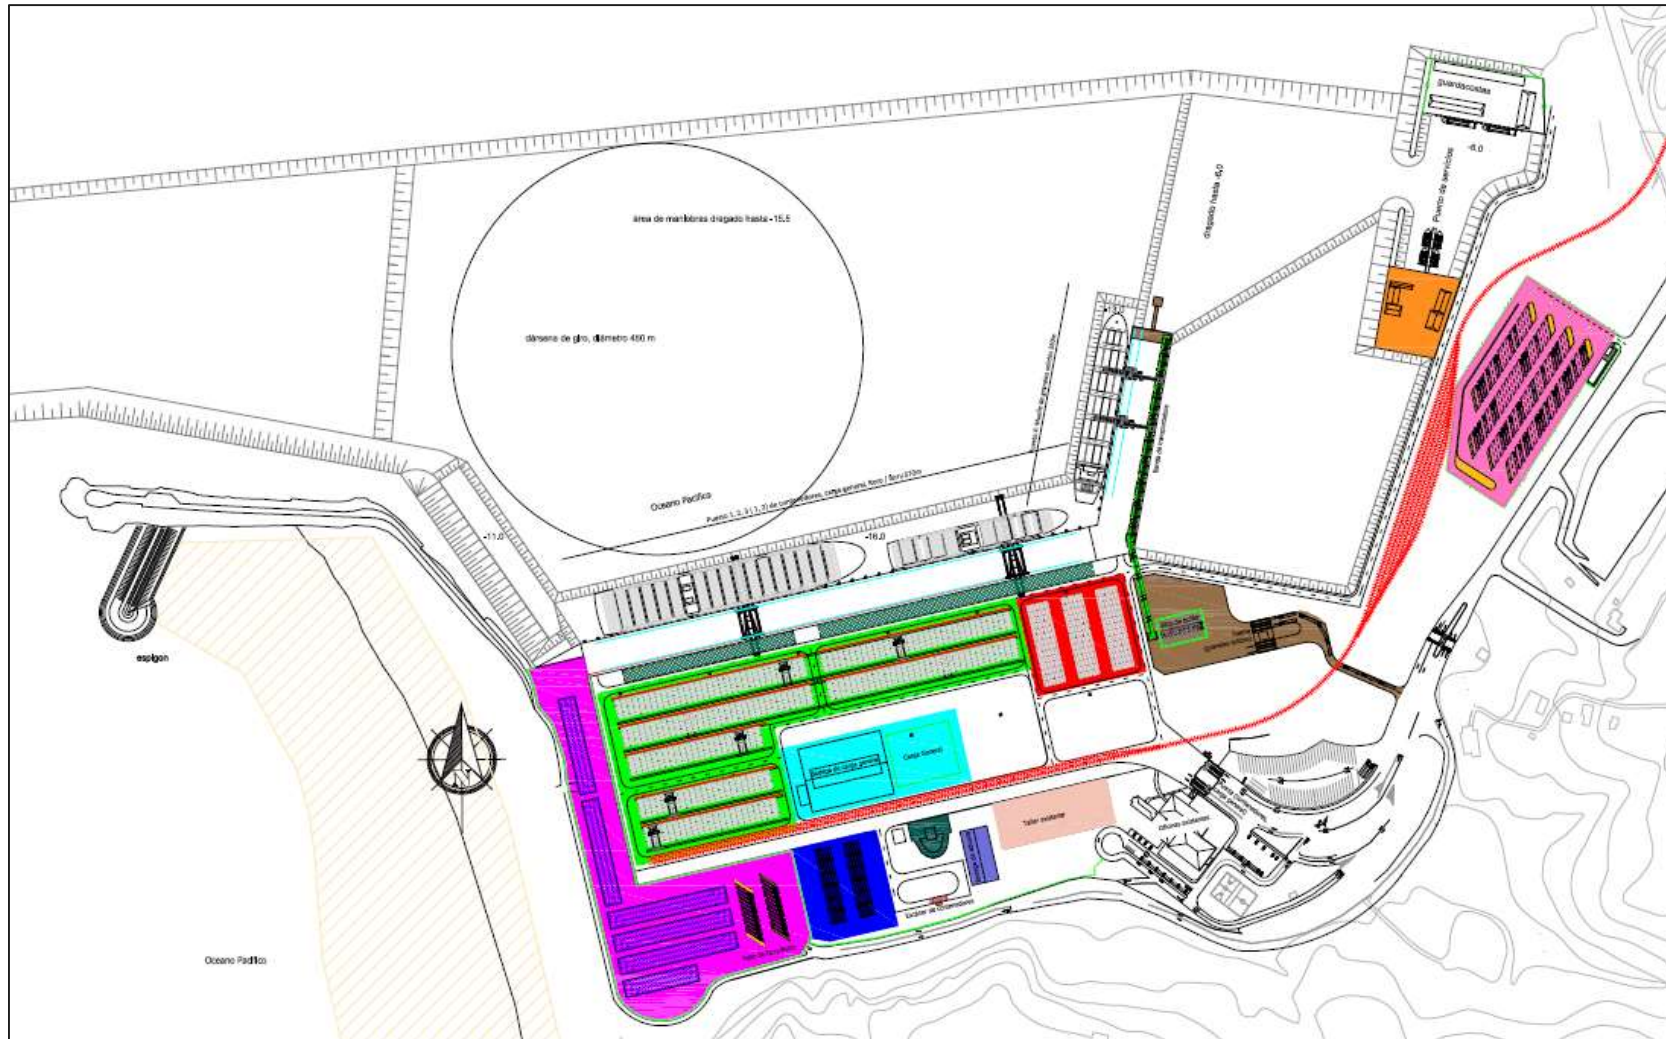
Plan Maestro de puerto Caldera Fase A
